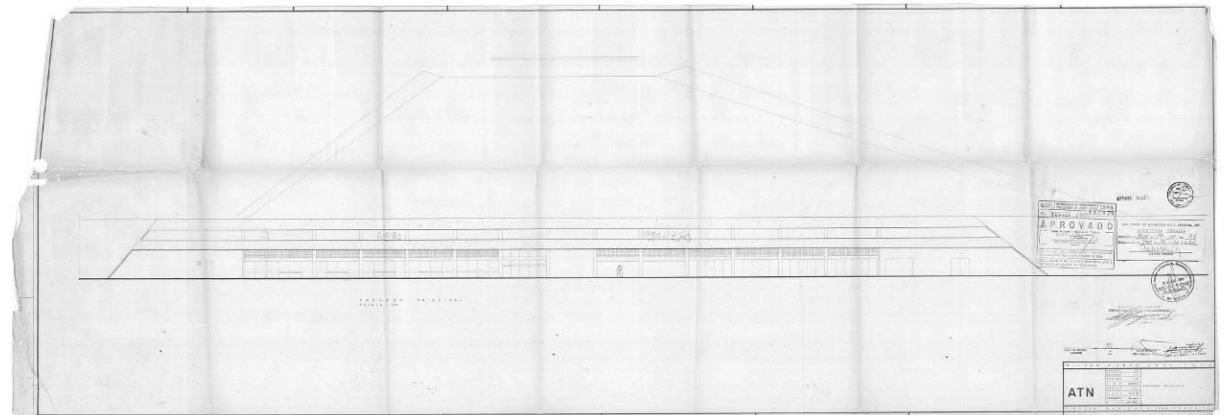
Fachada Norte (1976). Autor do projeto: Oscar Niemeyer. Carimbo: Milton Ramos Arquiteto, Projeto 104, Desenho 14, Arquivo 137. Conteúdo: Fachada Principal. Desenhista: Zoroastro. Data: 10/05/1976. Fonte: ARPDF.
